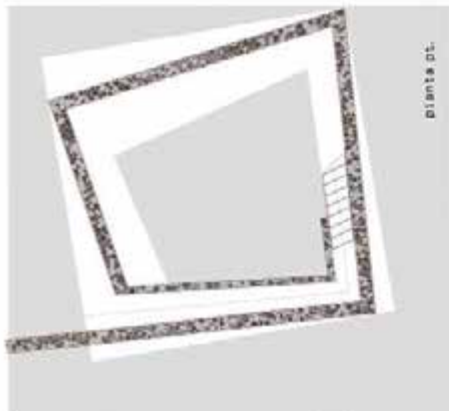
tavole di progetto: piante, prospetti e sezioni.
